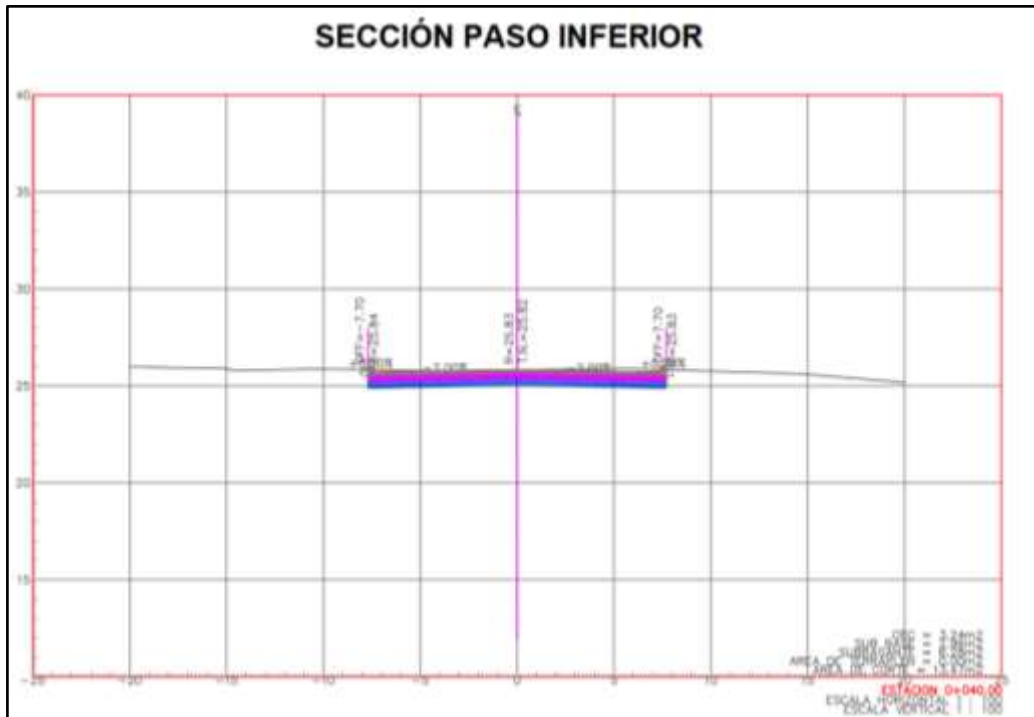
Seccion tipo Distribuidor vial Blvd. José Limón.
